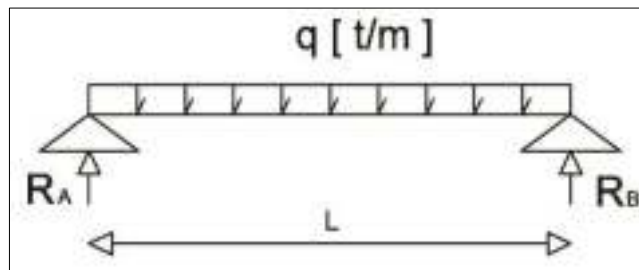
Viga simplemente apoyada con carga distribuida. (Mármol, 2010)
